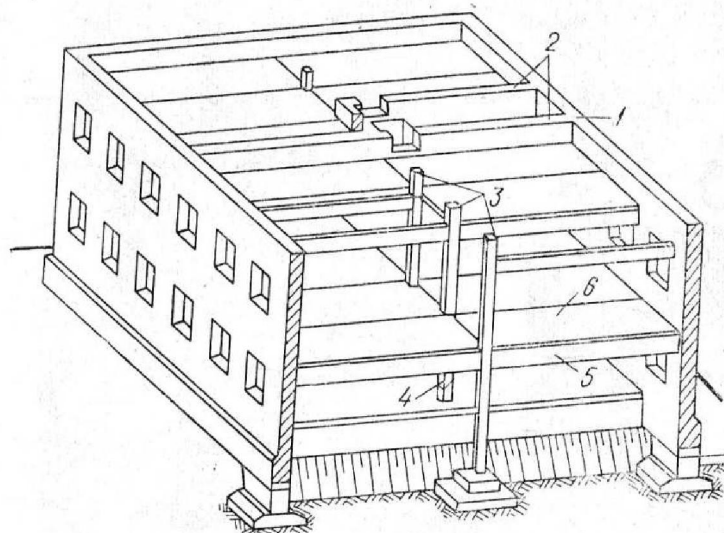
Здание со смешанным каркасом (1-несущие стены, 2- стены лестничной клетки, 3- колонны, 4- стык колонн, 5- ригели (прогоны), 6 – плита перекрытия.[60]
